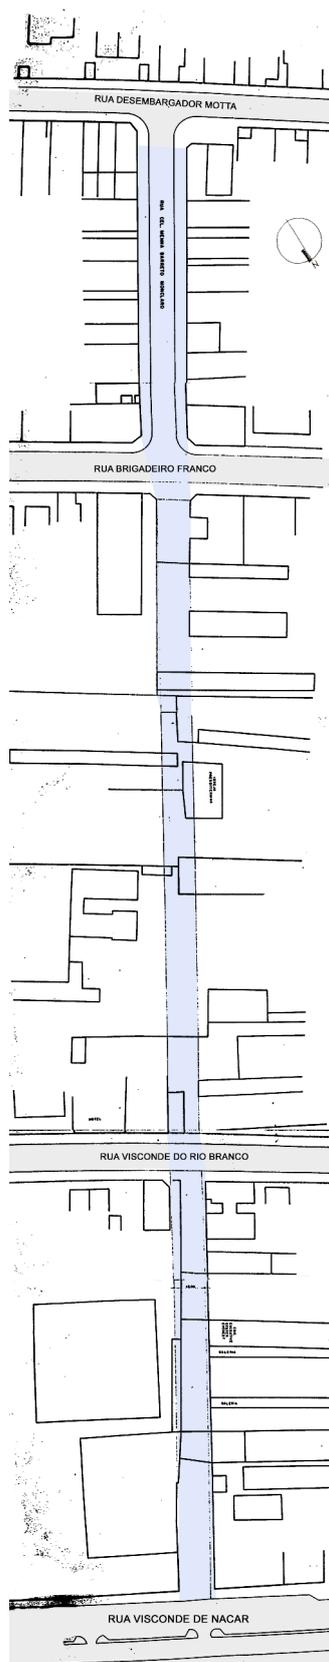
Planta da proposta original, Rua Menna Barreto.
